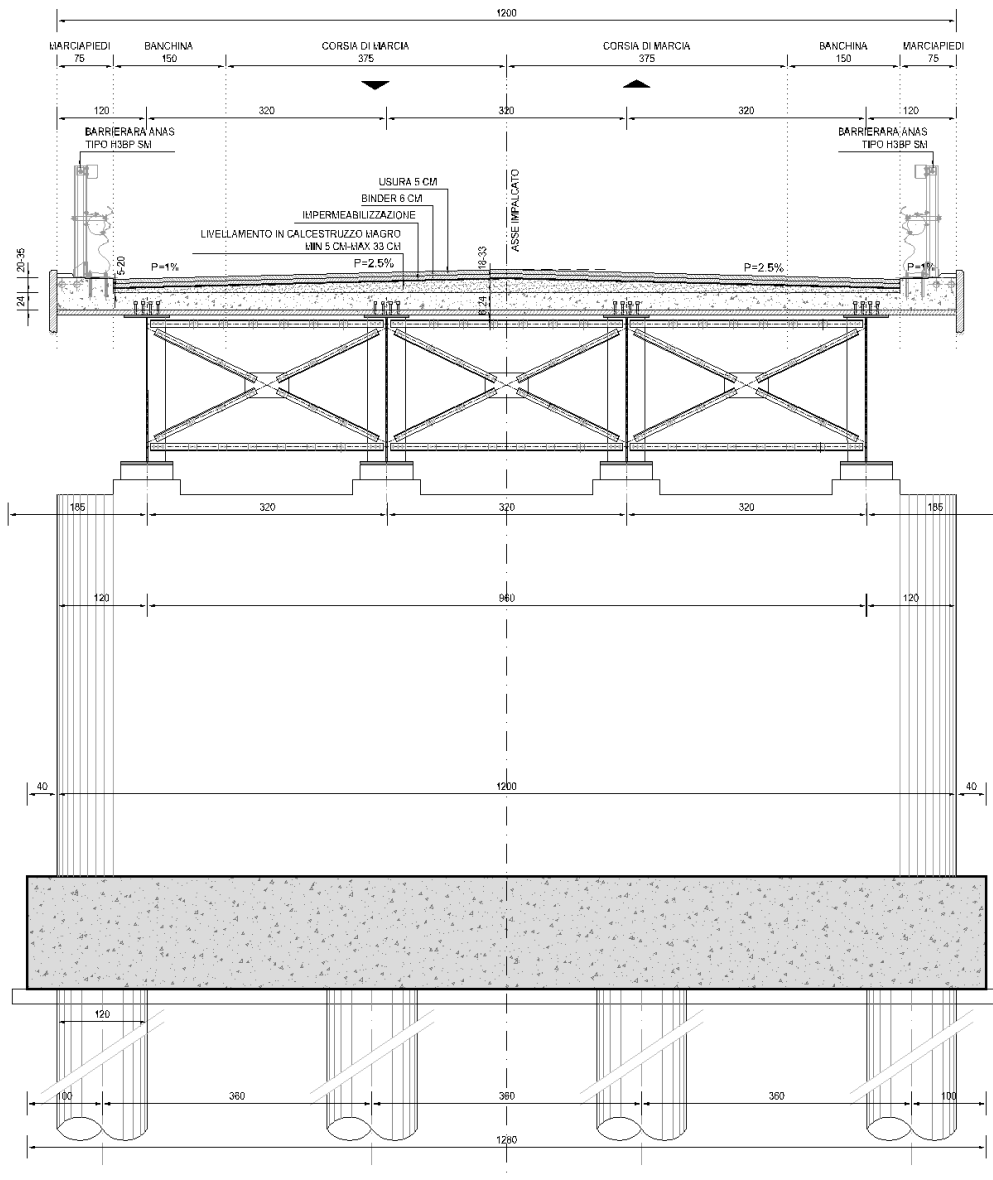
SEZIONE IMPALCATO (SU PILA)
